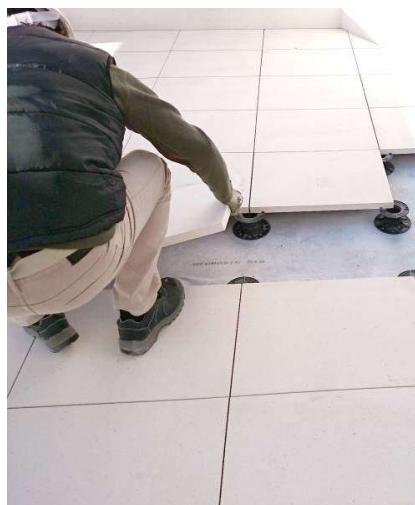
Ejemplo colocación pavimento sobre plots, (Fuente: <http://www.tectonica-online.com>)
